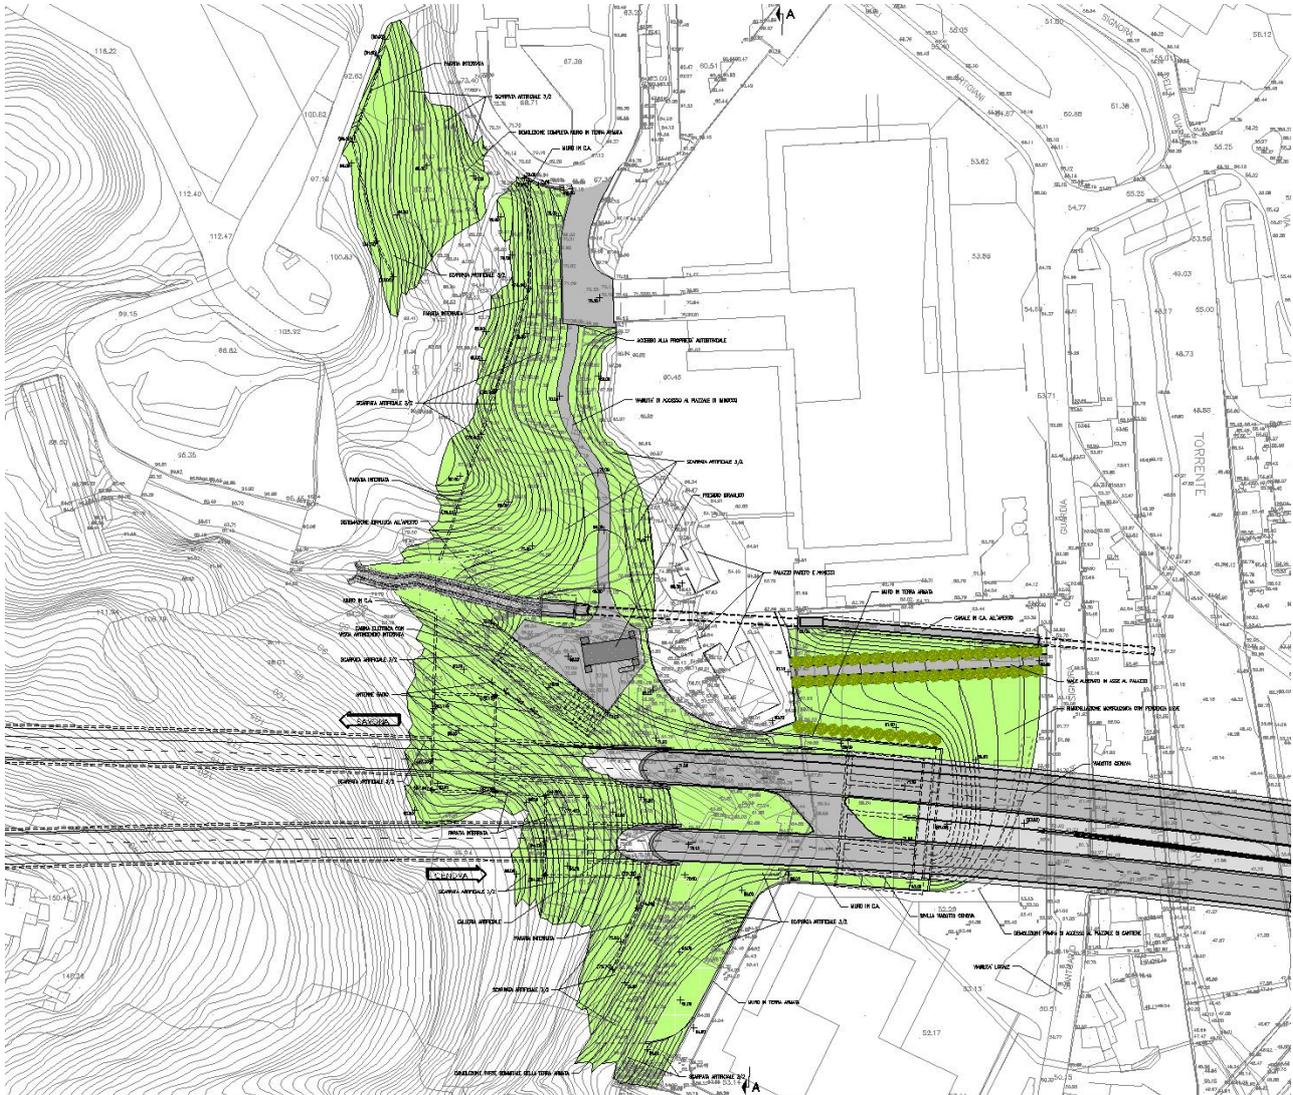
Planimetria dell'area di imbocco (cfr. AUA0151-2)
